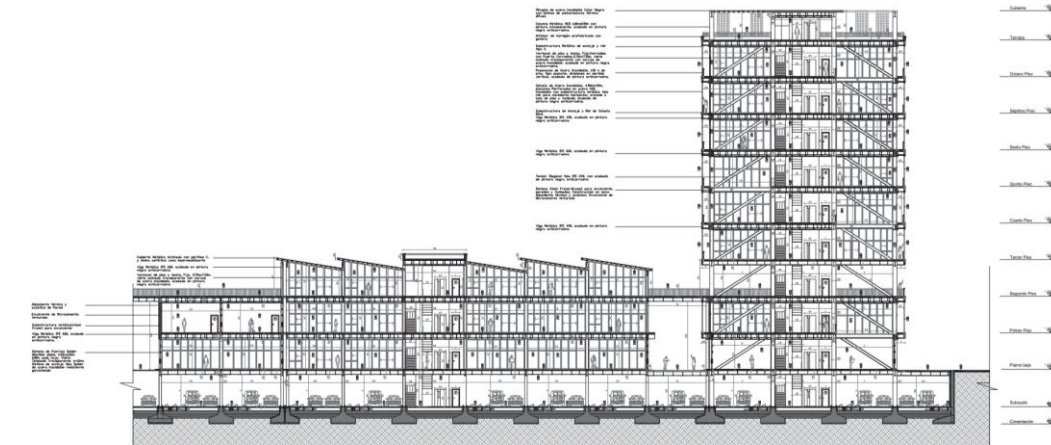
Corte Constructivo Centro Cultura y Torre Multifuncional. Fuente: Elaboración Propia
